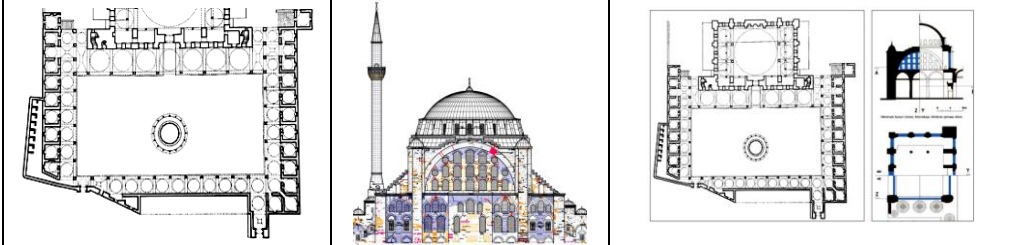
مسقط أفقي وقطاع ومنظور لجامع شهزادة باستانبول ضمن مجمعه يوضح الرواق الجانبي الذي يتقدم مخططه. (عن: كوران).
